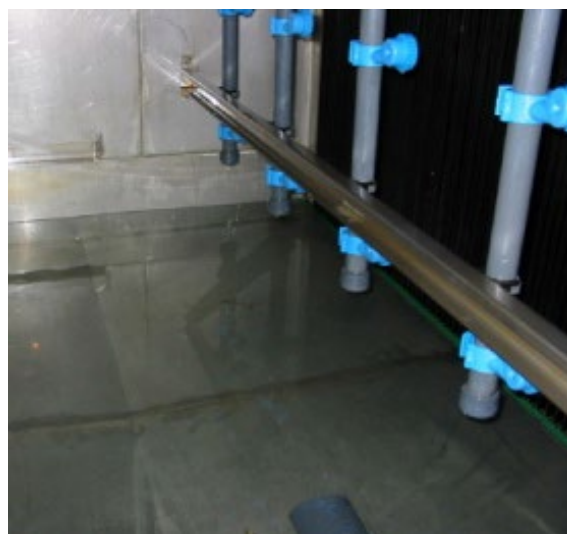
Hygienisch guter Umlaufsprühbefeuchter
